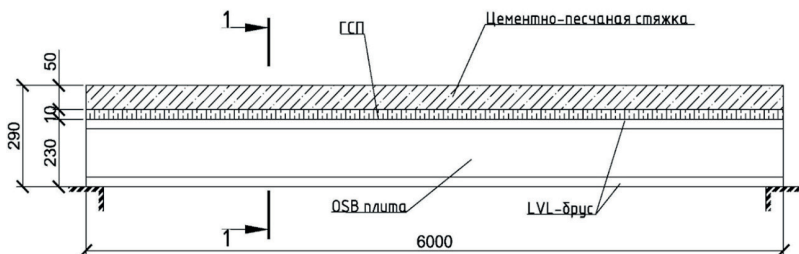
Деревянное перекрытие с учетом конструкции пола
